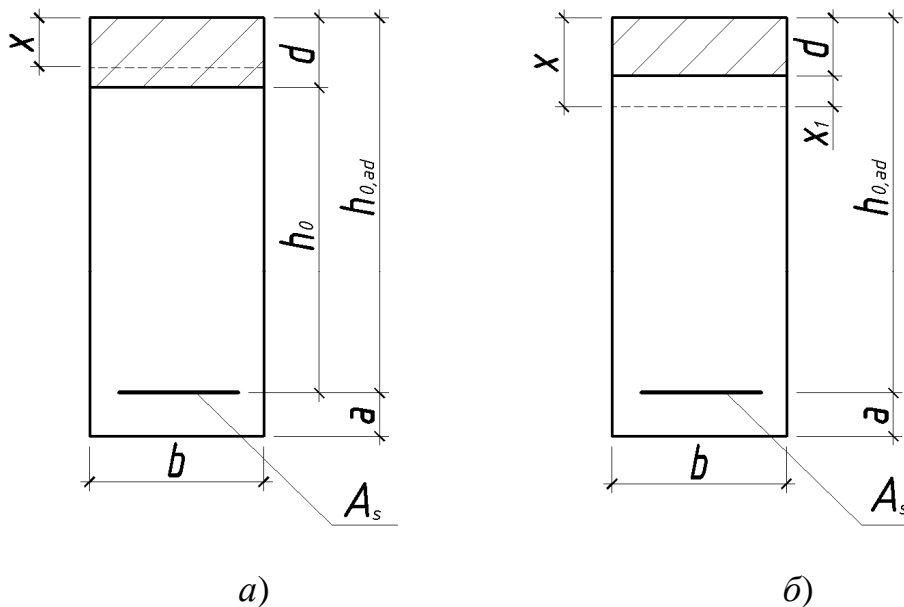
Розрахунковий переріз при підсиленні нарощуванням стиснутої зони:
